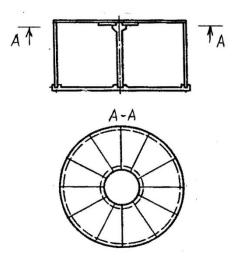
Схема закрытого цилиндрического резервуара с центральной опорой
